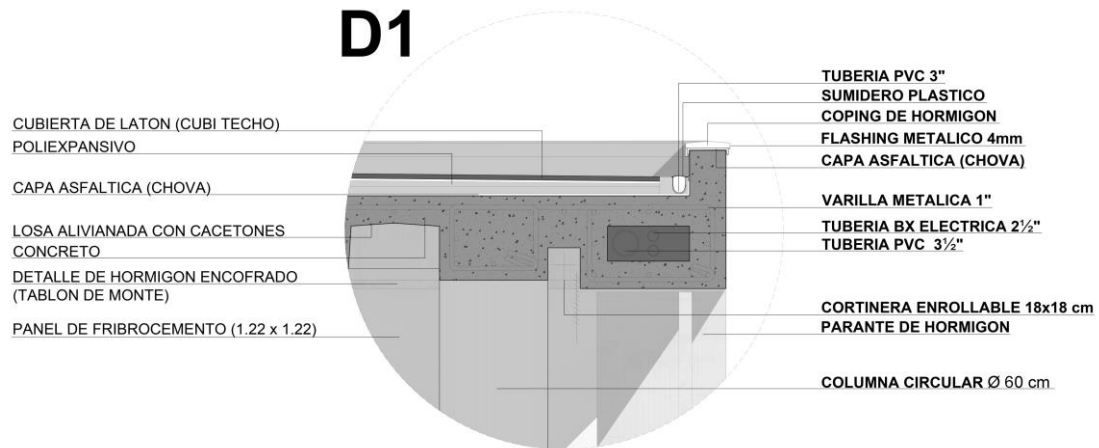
Detalle 1. Corte por fachada 1. Elaboración propia.
